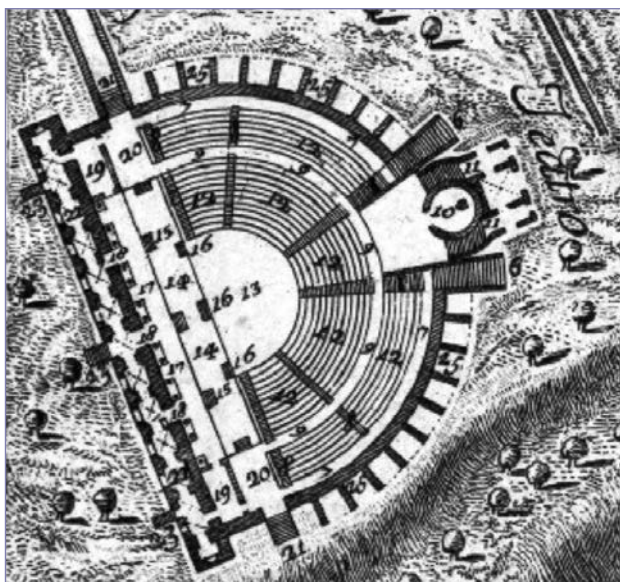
"Odeón" en la planta final de la planta de Piranesi (MACDONALD y PINTO 1995: 258).
